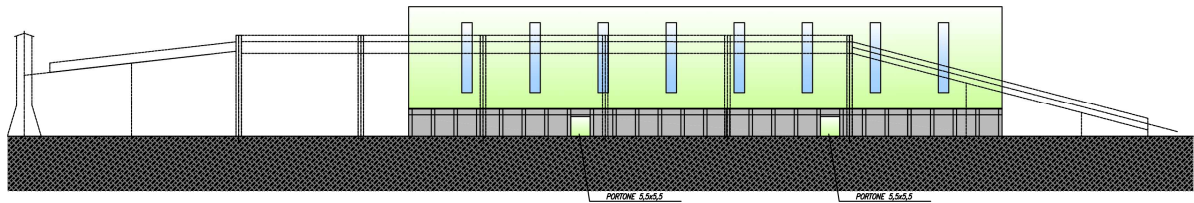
b Prospetto longitudinale della copertura proposta
